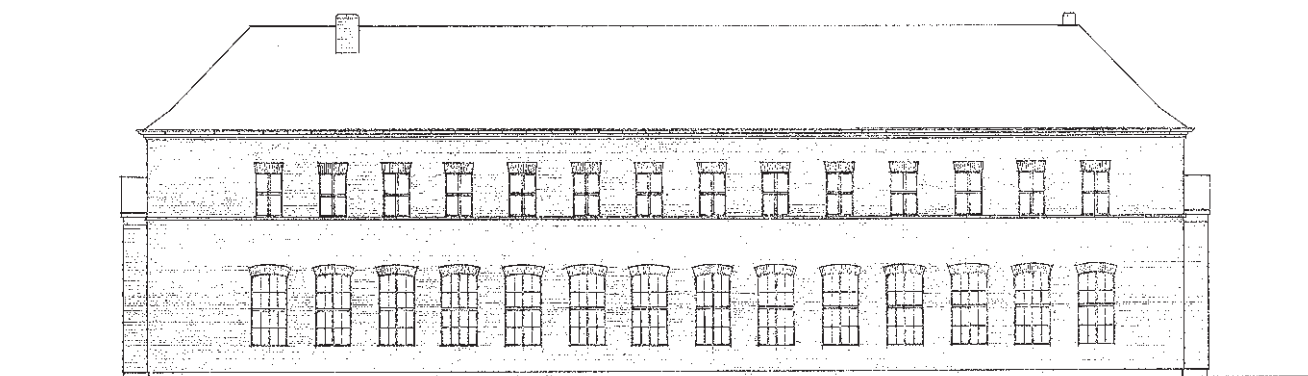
Wizja architektoniczna elewacji wschodniej warsztatów naprawy wagonów (1940 r.)
